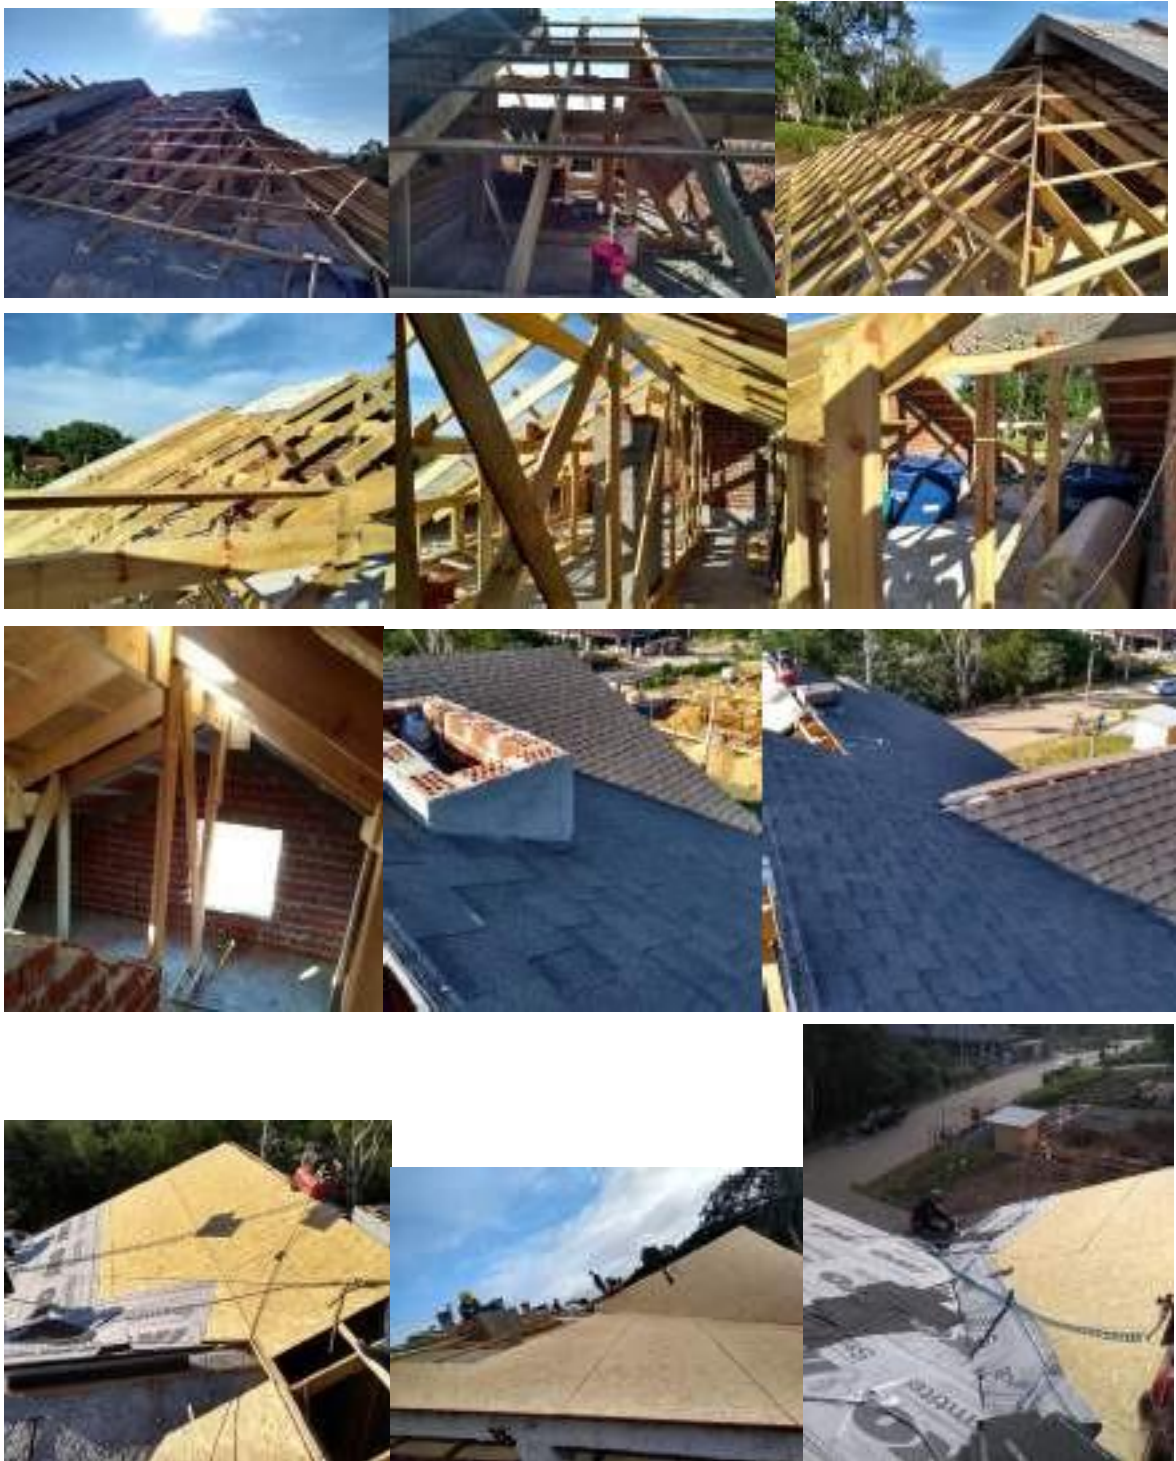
,09,10,11,12 ,13: detalhe construtivo das tesouras do telhado e contraventamento
